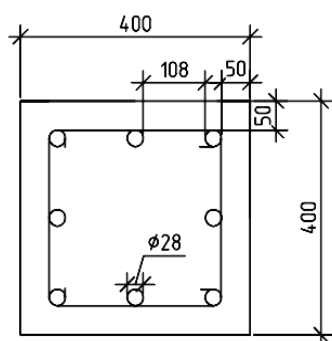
Схема колонны квадратного сечения с гибким армированием (вариант 5) – квадратное сечение с гибкой арматурой.
